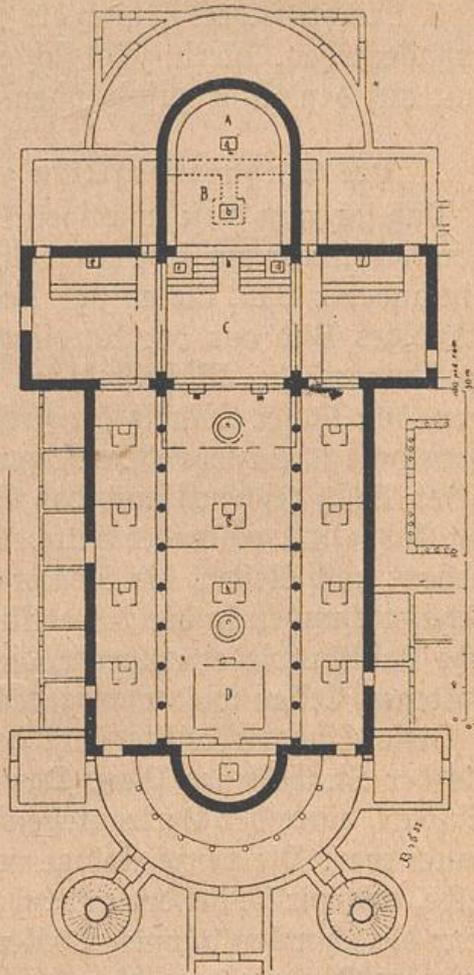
Grundriß der Klosterkirche von St. Gallen.
